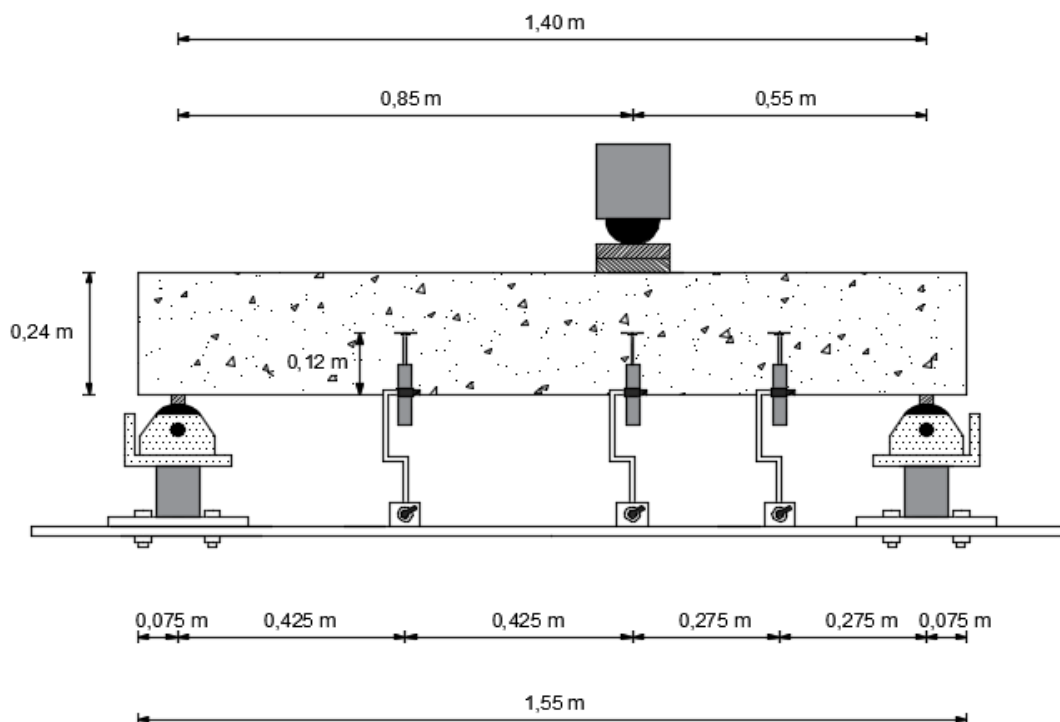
Viga preparada para ensaio – ensaio à flexão
